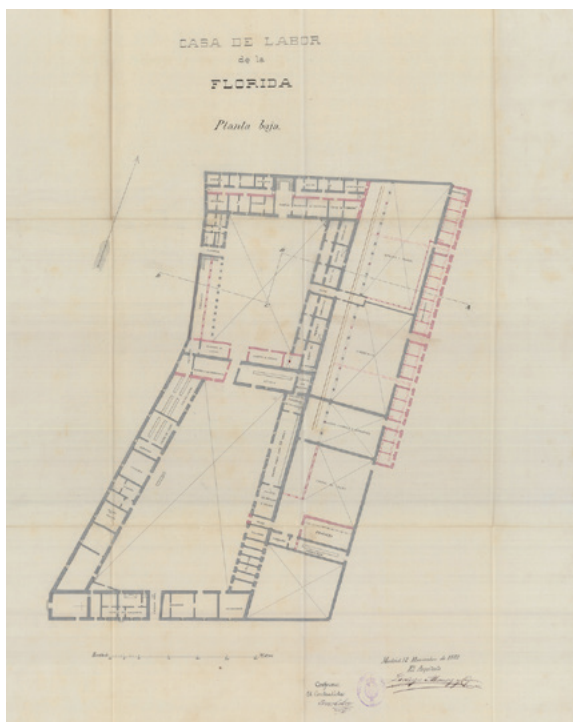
Casa de Labor de la Florida. Planta baja. Lorenzo Álvarez y Capra, 1881. Fuente: AGA, Fondo Ministerio de Educación, IDD (05)001.025, Caja 31/08132.
